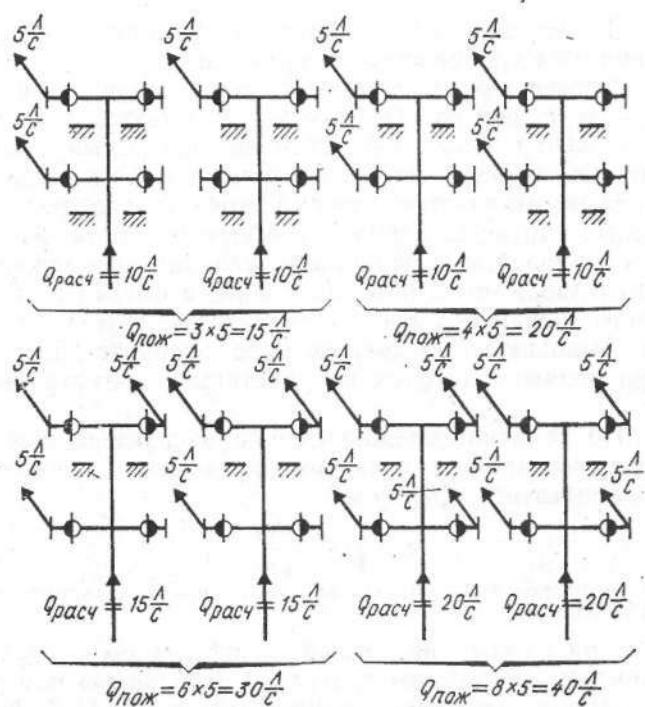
Расчетные схемы внутренних противопожарных водопроводов в зданиях повышенной этажности
